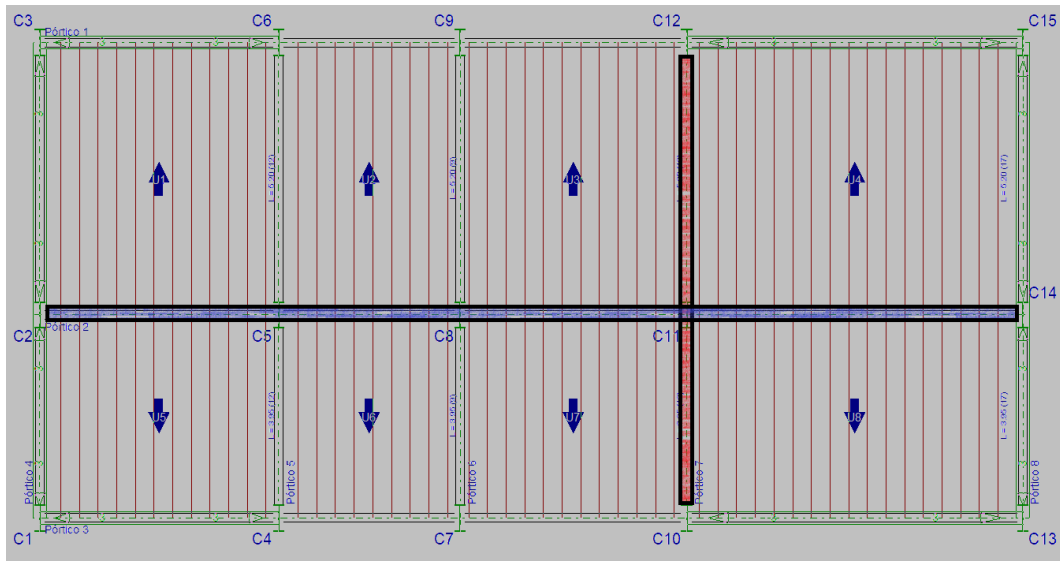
Vigas más cargadas en el forjado 4 (Cubierta)
